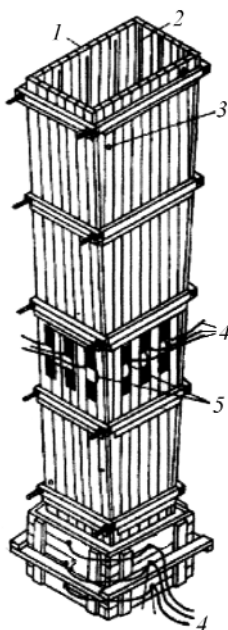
Опалубка с нашивными электродами для прогрева колонны: 1 – щиты опалубки; 2 – нашивные электроды; 3 – отверстие для термометра; 4 – провода питания электрической сети; 5 – перемычки между электродами
